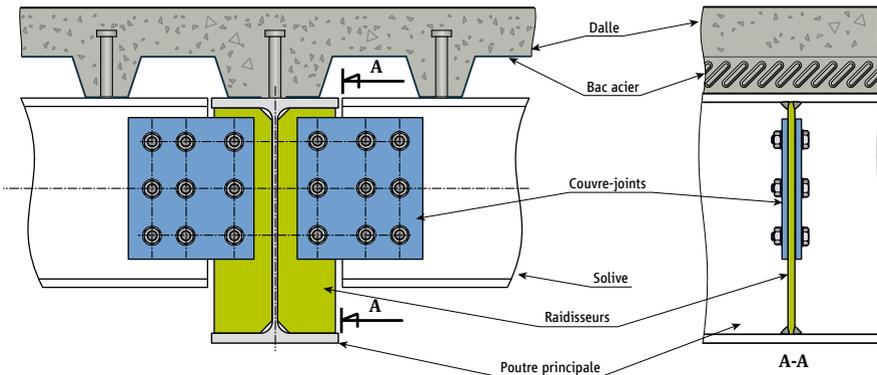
Assemblage d'une solive sur une poutre intermédiaire par couvre-joints
